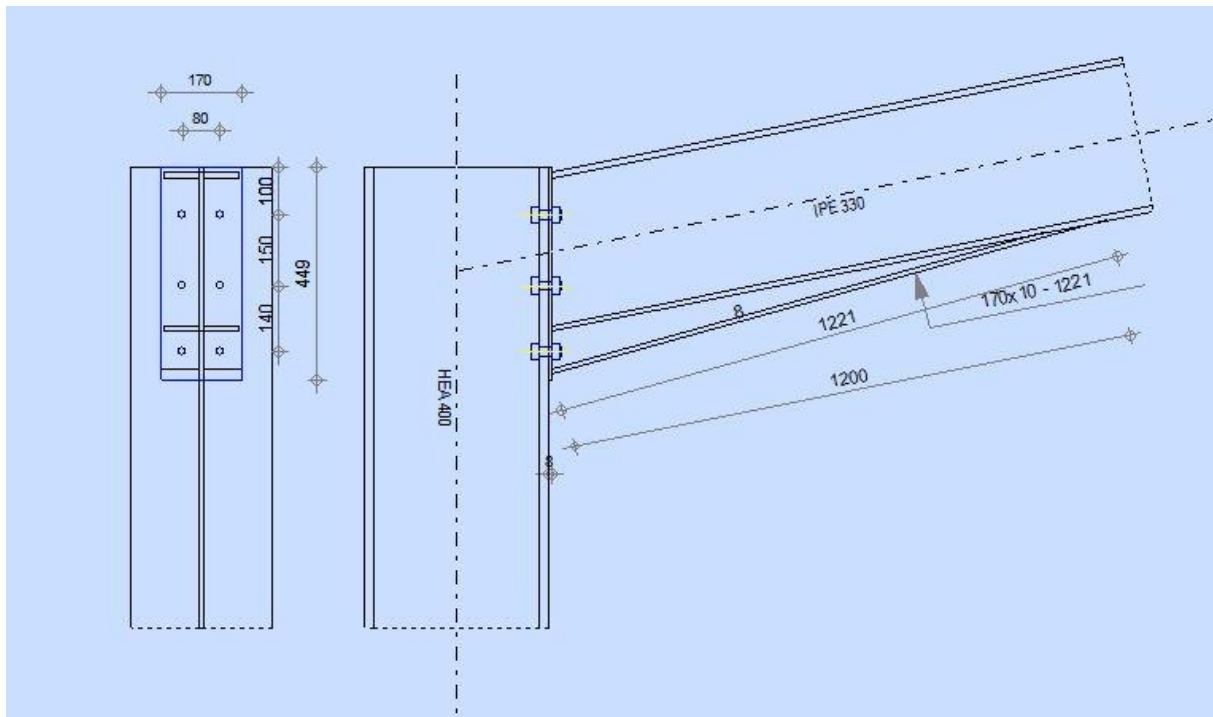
Détail sur l'assemblage poteau traverse IPE330.
